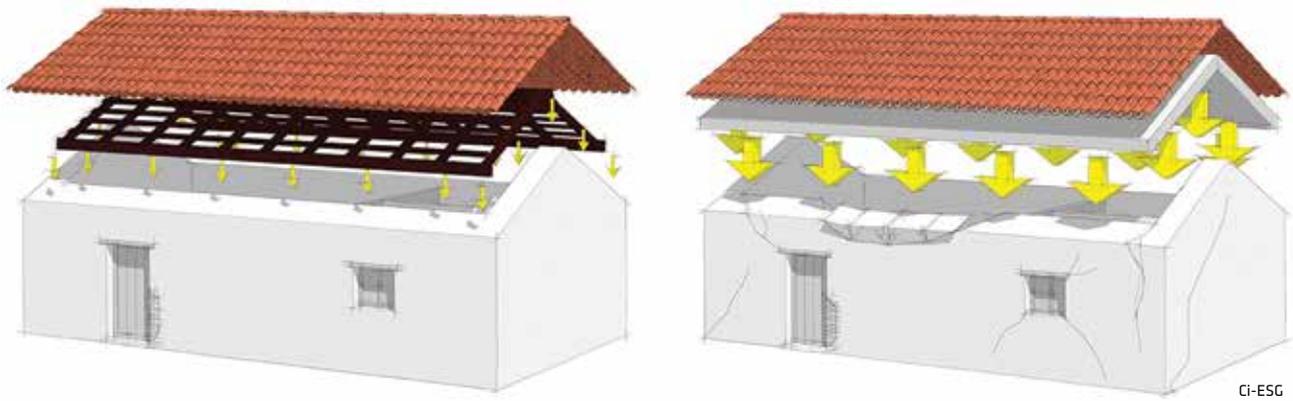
Principais modos de colapso das paredes para fora do seu plano Main type of wall collapse out-of-plane
